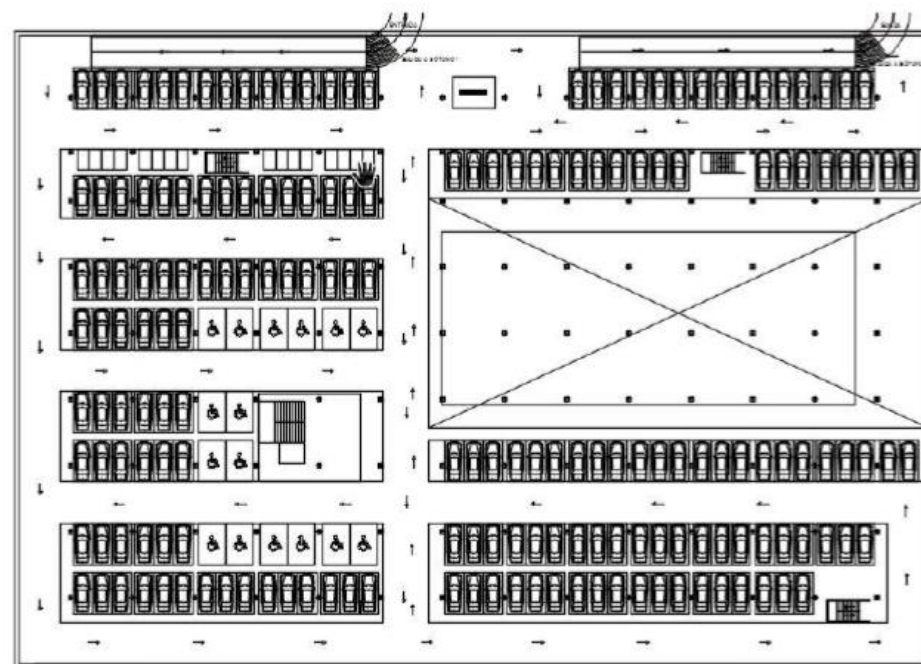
Vista de planta de la opción escogida de distribución interior del aparcamiento. Fuente: Propia
